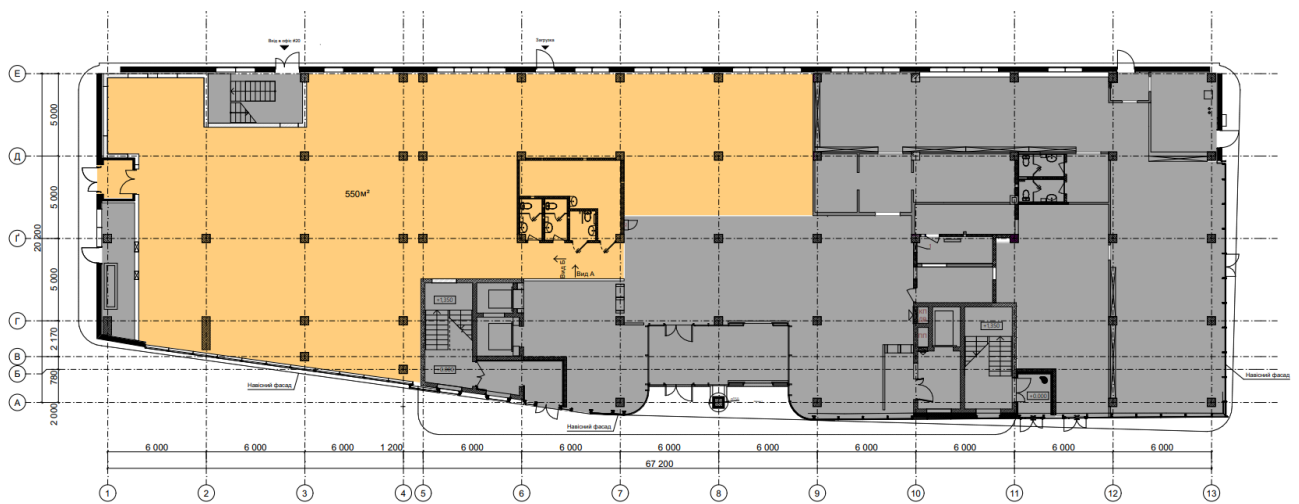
План 1-го поверху зі зоною розробки.
